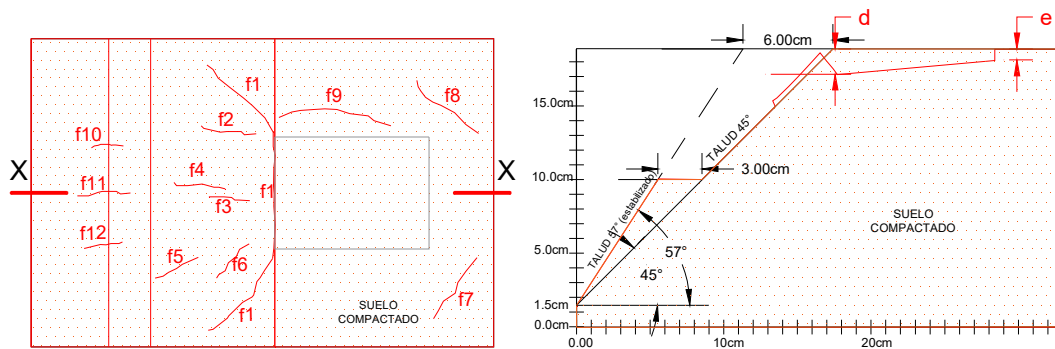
Vista en planta y corte X-X, del modelo talud Estabilizado Ensayada a escala reducida (P-3).
